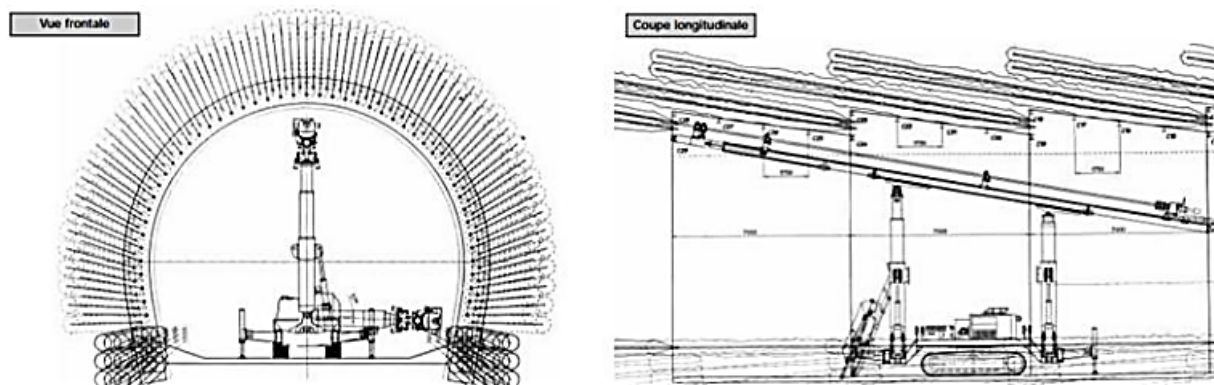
Profil type de soutènement avec voûte parapluie constituée de tubes métalliques [4]
